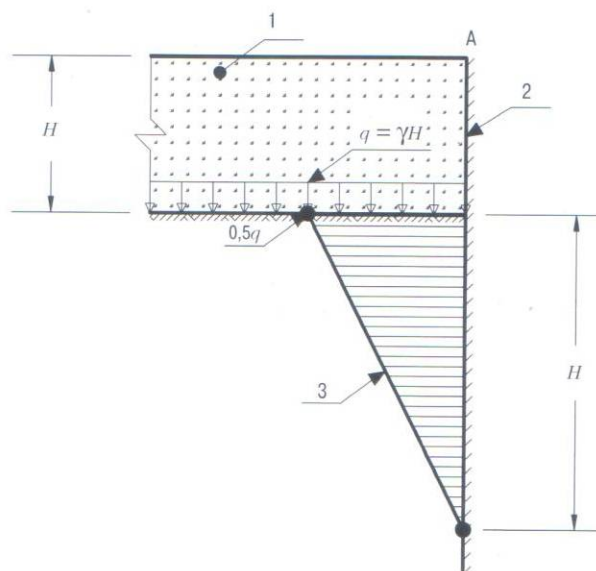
Замена криволинейной эпюры горизонтального давления треугольником:
